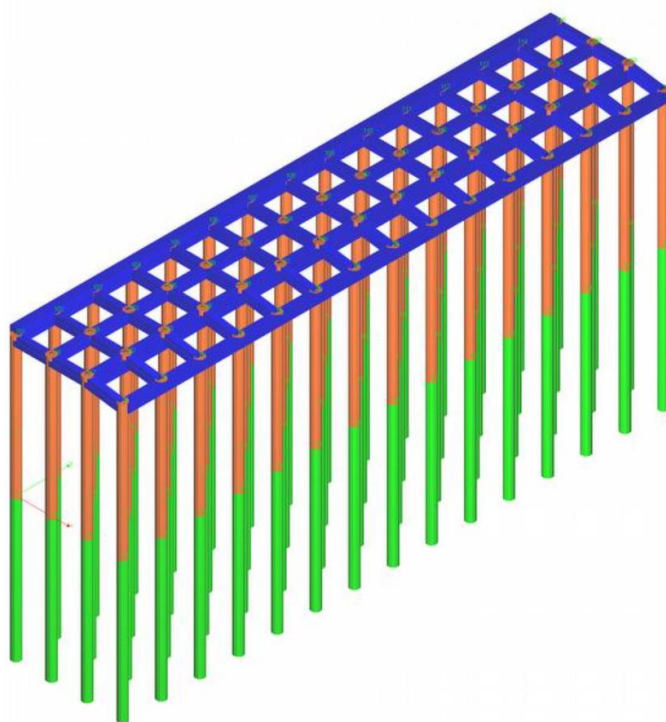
Modello tridimensionale IMPALCATO 6 - Chiapparo
